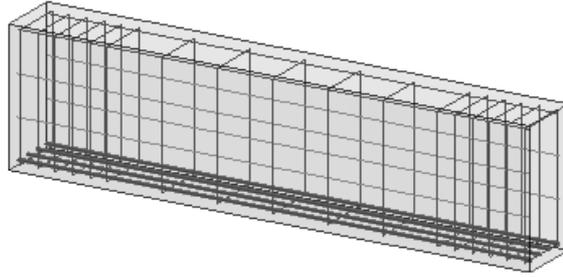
Armado de viga rectangular (Tekla User Assistance, 2013)
